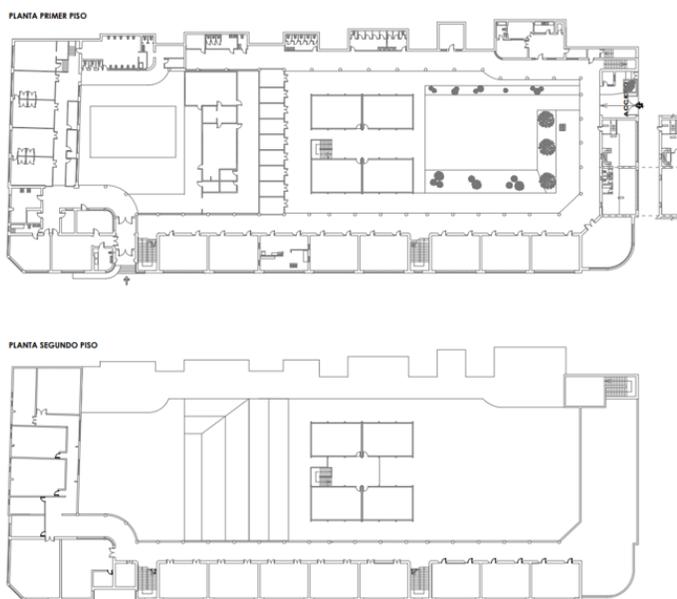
Planos en planta del liceo, 1 y 2 nivel.
